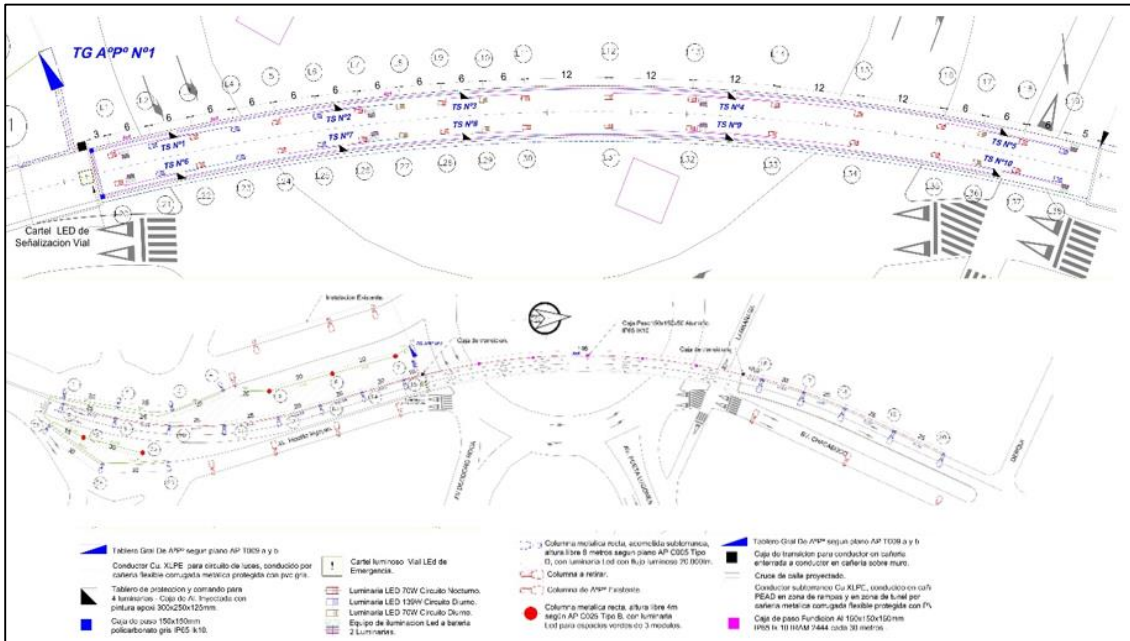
Proyecto ejecutivo de alumbrado público (PLANO N° 12)
